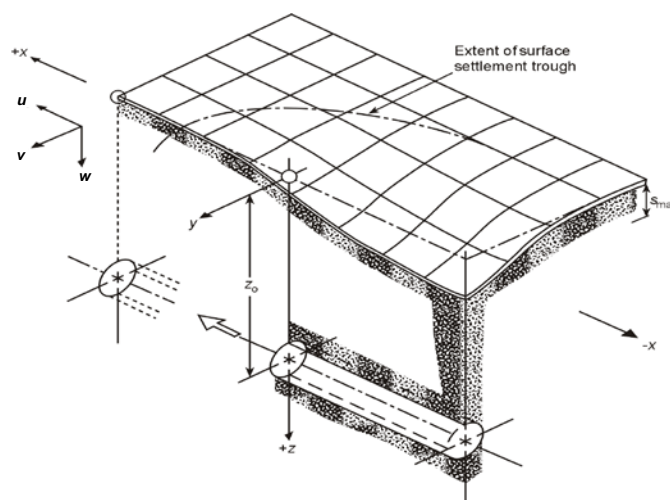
Geometría de asentamientos inducida por la excavación de un túnel (Attewell y Yeates et al., 1986)
